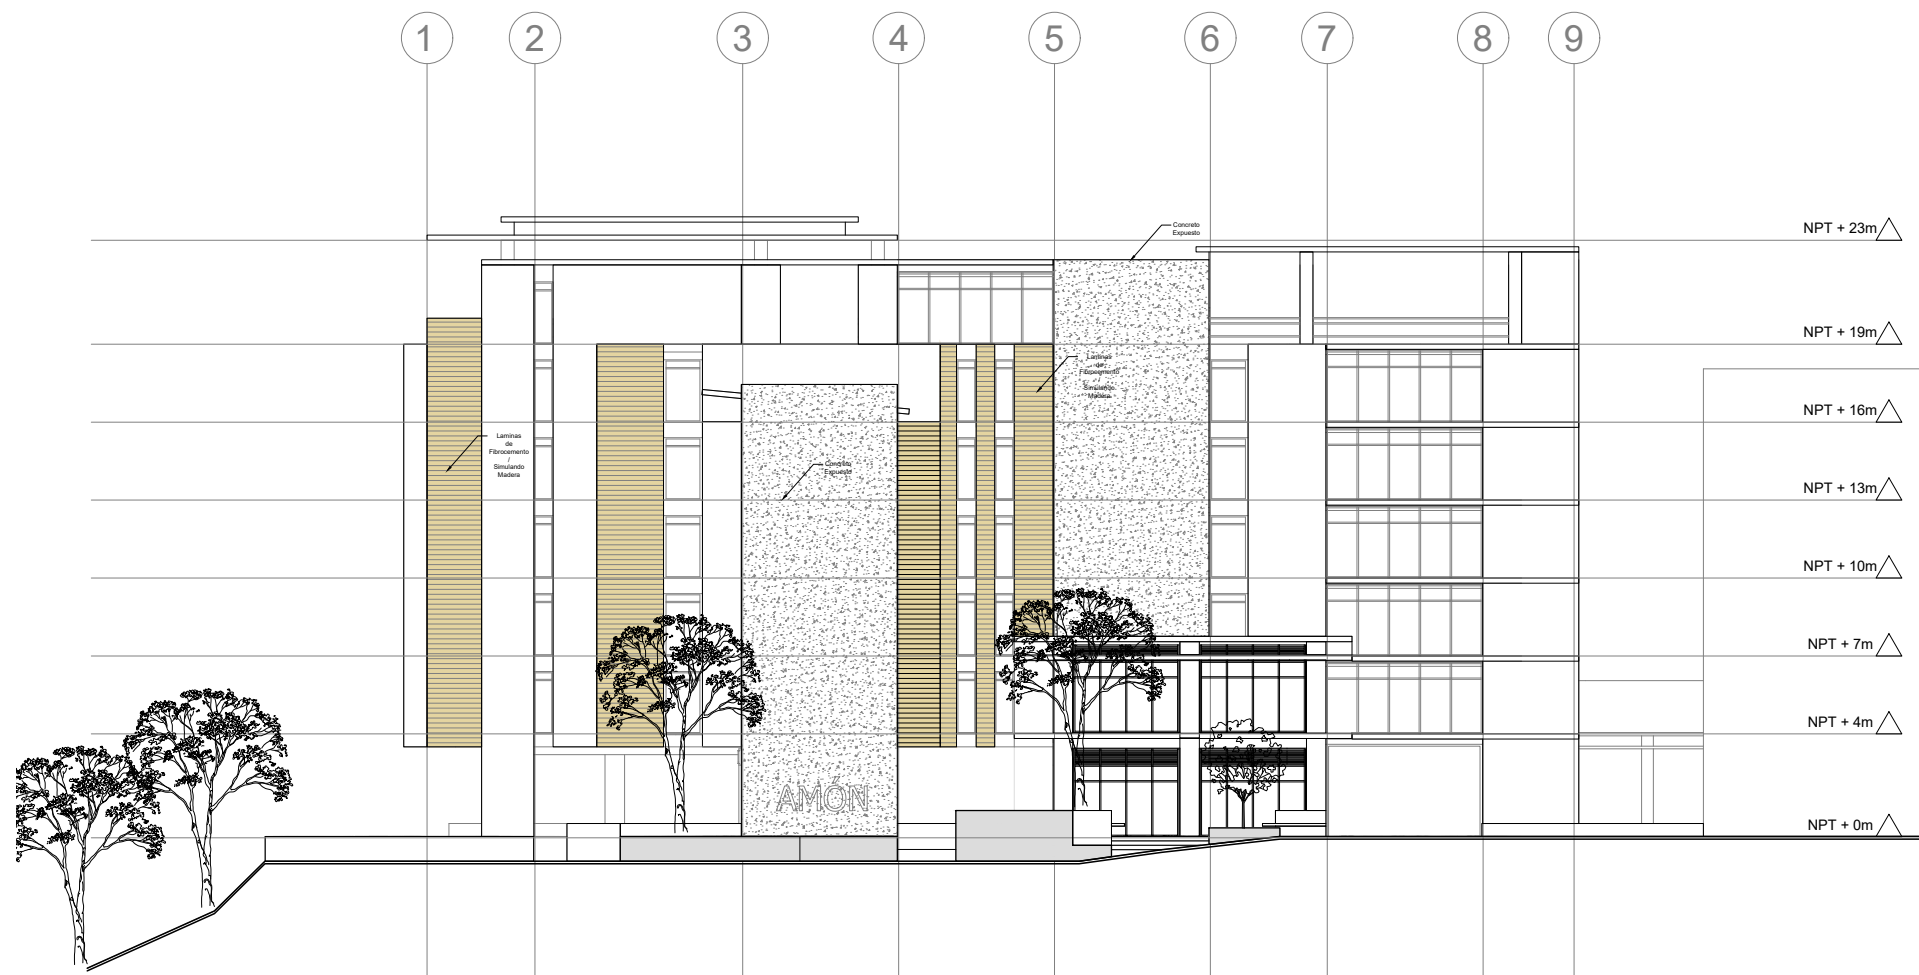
Fachada oeste. Fuente: Elaboración propia.
